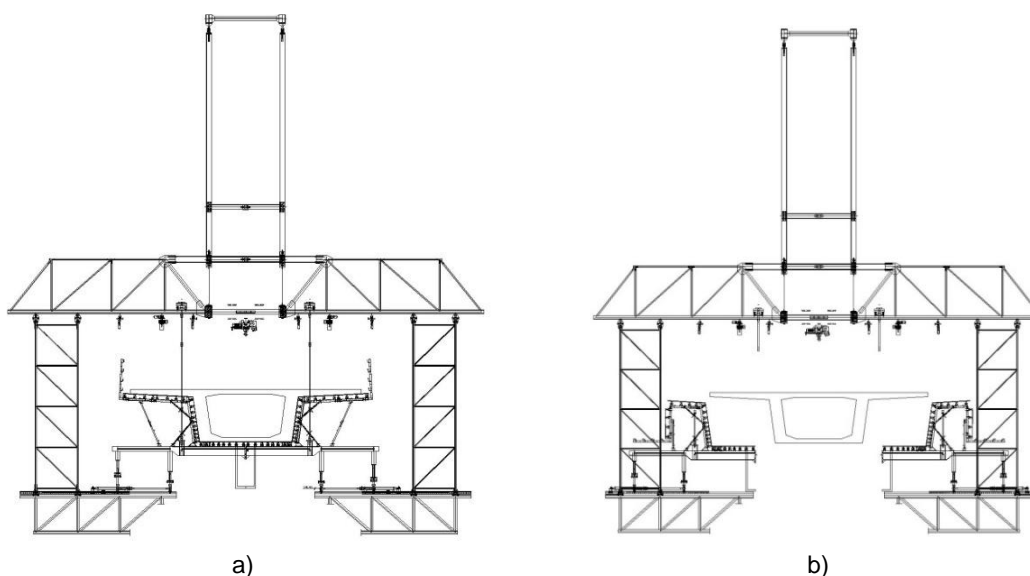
Secção transversal do cimbra em fase de betonagem, a) e em fase de avanço, b) [29].
